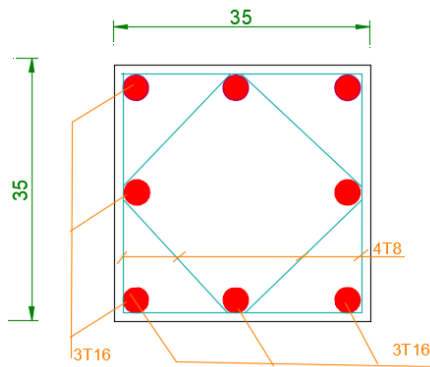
Schéma De Ferrailage Des Poteaux de 12^{ème} étage.
